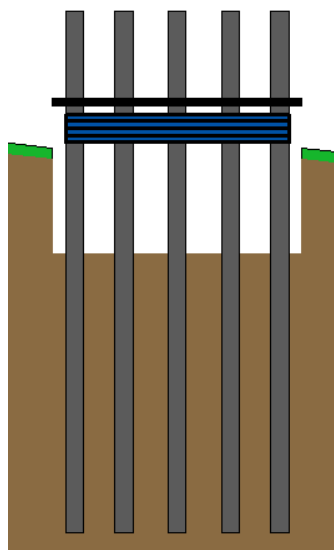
Выемка грунта до отм. -12.000.
